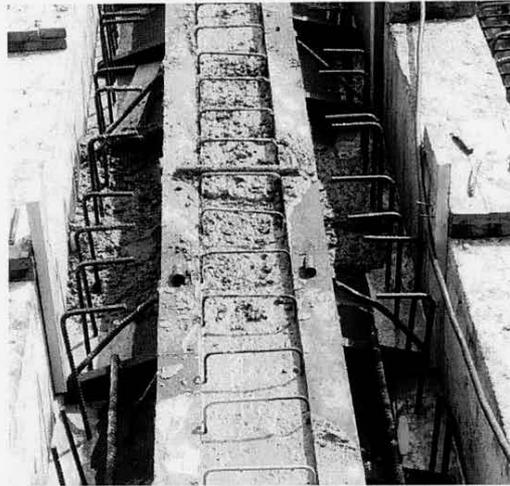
, 3 y 4 – Losetas pretensadas prefabricadas
